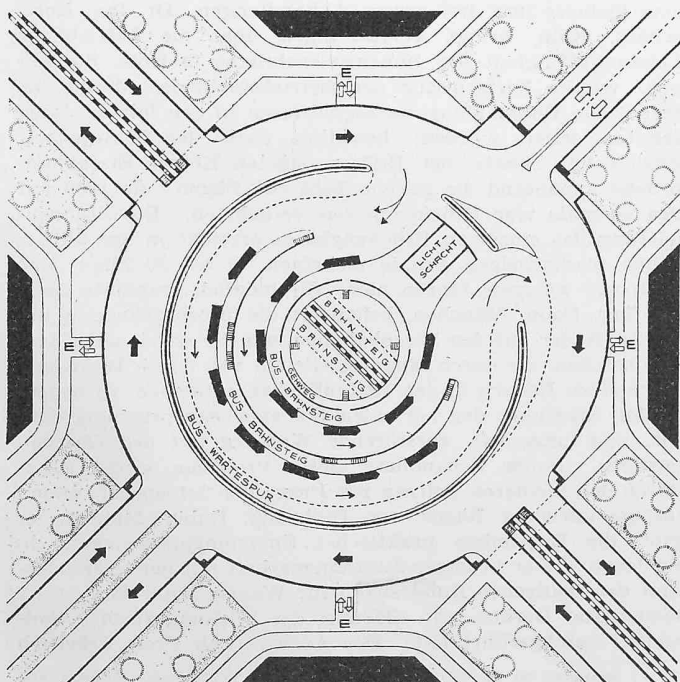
Grundriss der Anlage Bild 3 (W = wartend)
